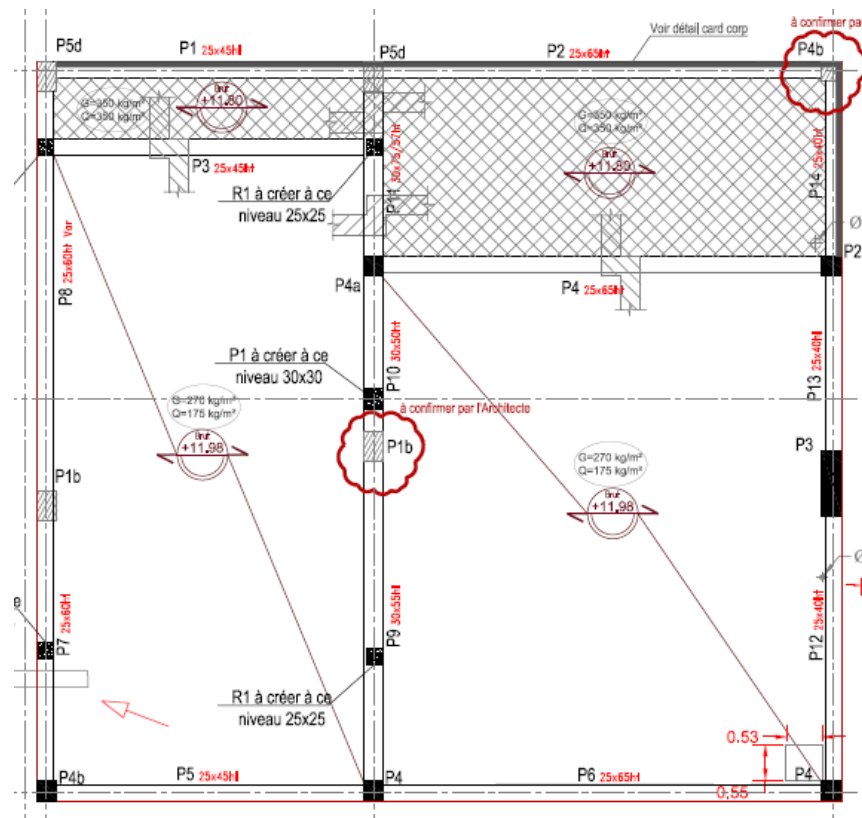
PLAN DE COFFRAGE DALLE PLEINE JOINT 23 PH R+2
